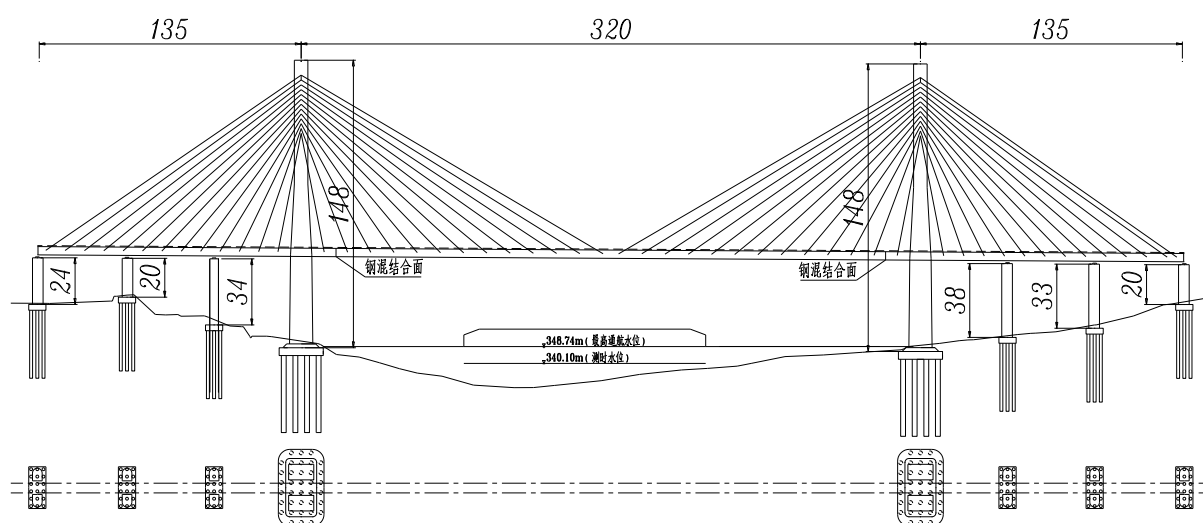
资阳西沱江特大桥混合梁斜拉桥立面布置示意图 (单位: m)
